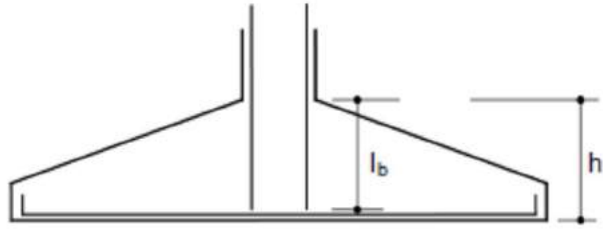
Ancoragem das armaduras de arranque do pilar (ALVA, 2007).
